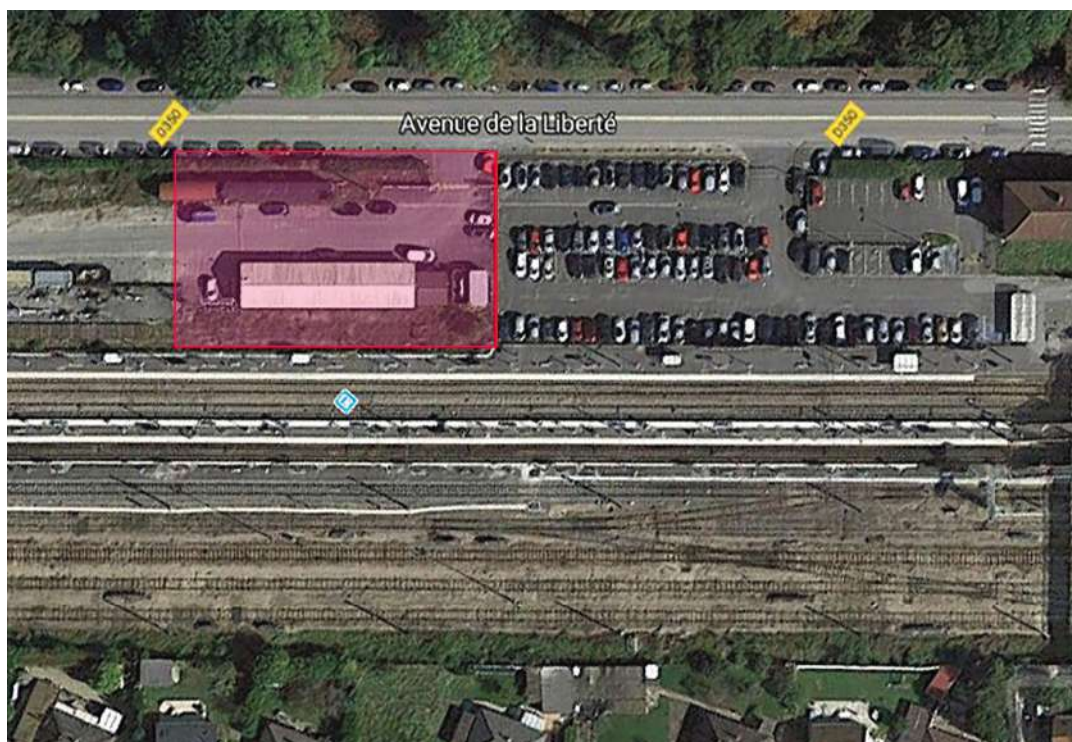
Plan de situation de l'emprise retenue pour l'implantation de la Résidence Traction (Source : SNCF Réseau)
